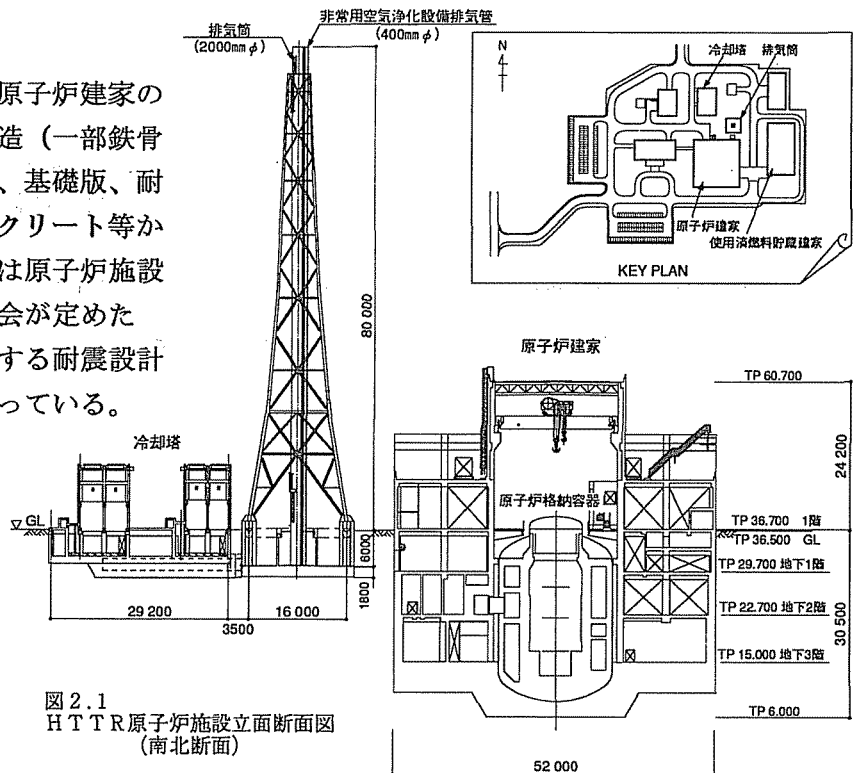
HTTR原子炉施設立面断面図 (南北断面)
